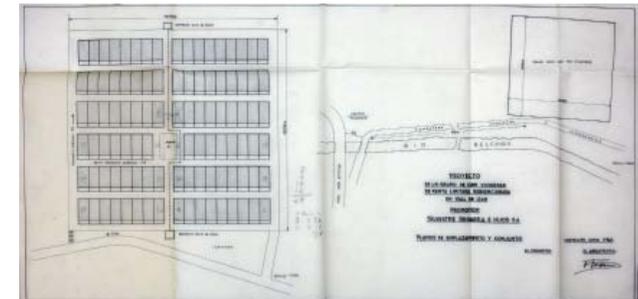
Plano de emplazamiento y conjunto Grupo de la Cova
